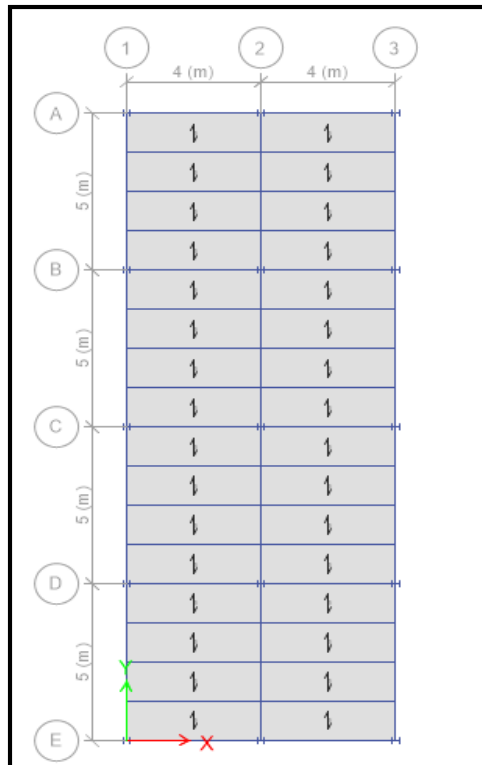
Planta de la edificación con pórticos arriostrados.
